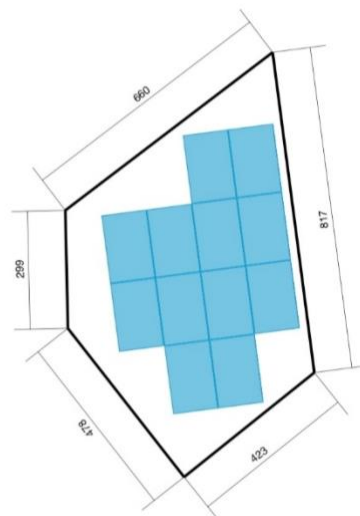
Schulhausstrasse 3, Belegungsplan, Dachfläche 2
